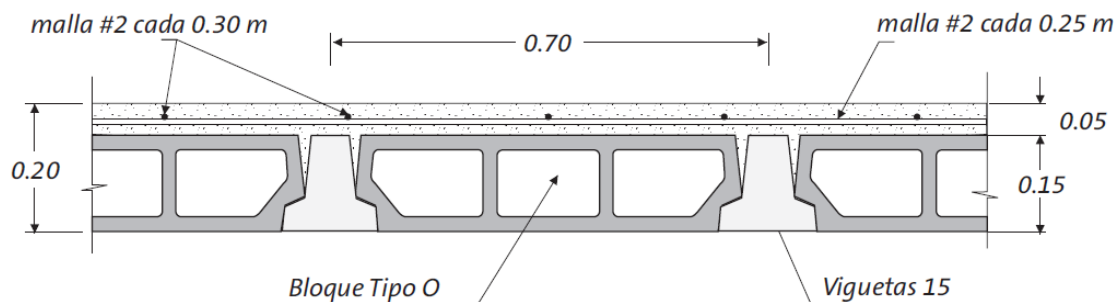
Esquema de sistema de entrepiso con viguetas prefabricadas de concreto reforzado (Productos de Concreto, 2016). La distribución de las paredes del primer y segundo nivel es la misma. En la Tabla 4-3 se definen 12 secciones de paredes de mampostería. Estas secciones se muestran en la Figura 4-9, donde el nombre de cada elemento corresponde al eje sobre el cual corre el muro. En esta tabla, las tres últimas columnas corresponden al valor de la rigidez lateral agrietada, definida en la ecuación 4-2, modificada por el factor de 1.14 determinado en la sección anterior (señalada con la letra “m”). Además, se muestra la inercia o segundo momento de área (I_{cr}) correspondiente al valor de rigidez agrietada obtenida (K_{ce}) con la ecuación 4-2 al considerar el módulo de elasticidad constante.
